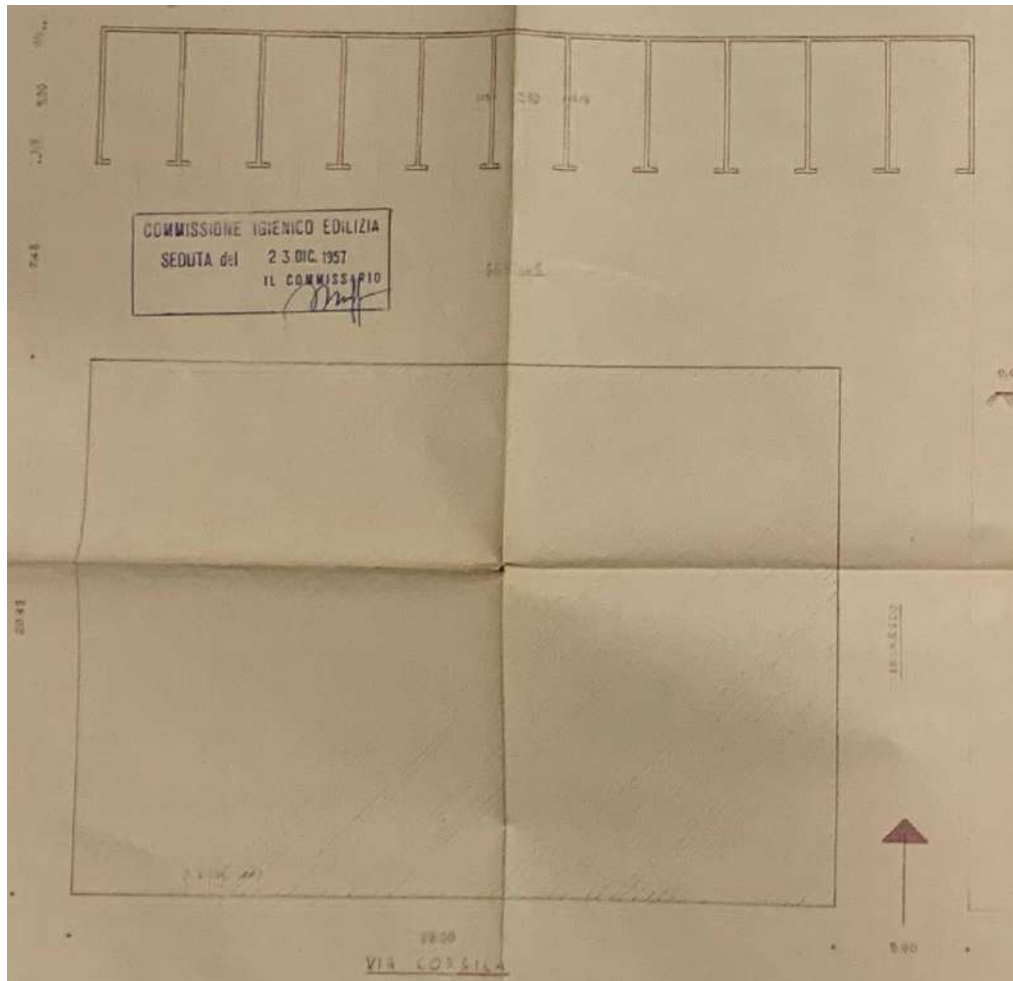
Estratto Di. N.1215 allegato alla Licenza edilizia n. 39010=7739 del 08.02.1958 – pianta
